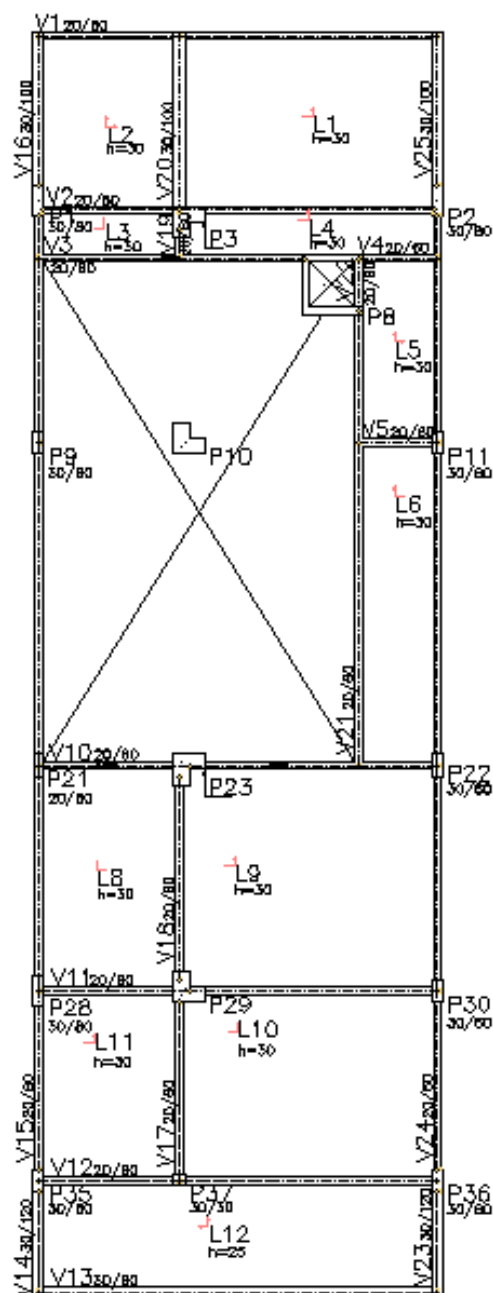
Desenho de fôrmas do pavimento Biblioteca da Solução Convencional
